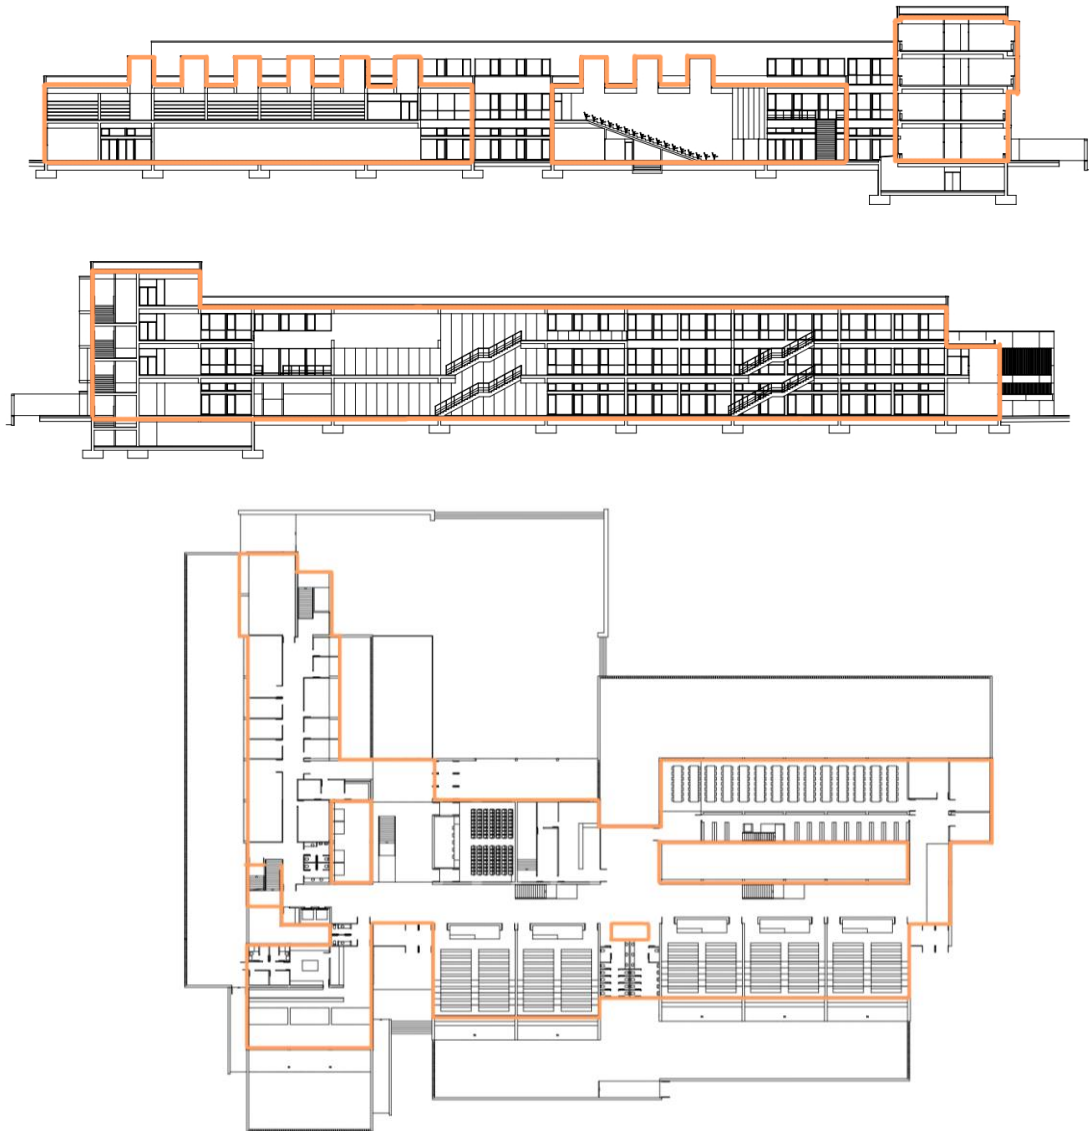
Esquema indicativo de la envolvente térmica en planta y sección. Fuente: Elaboración propia
